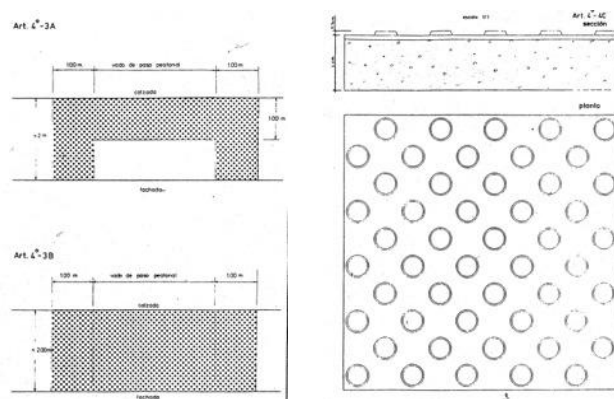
> Ordenanza sobre la supresión de barreras arquitectónicas en la vía pública (Ajuntament de Barcelona 1979)
